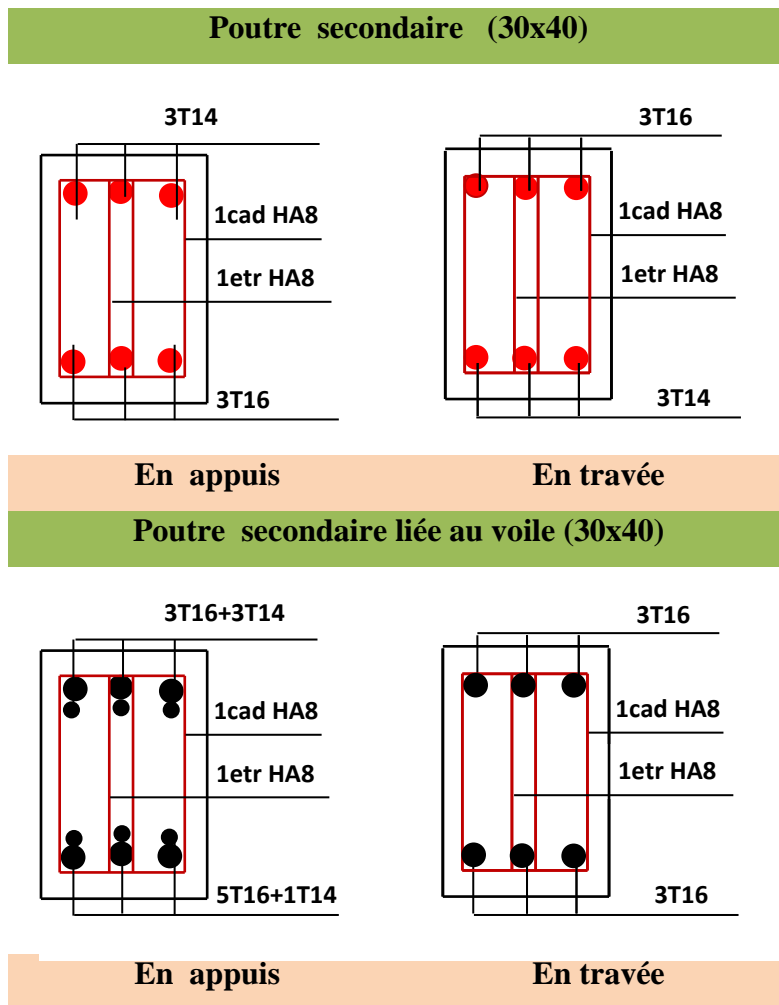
Schéma de ferrailage des poutres secondaire
